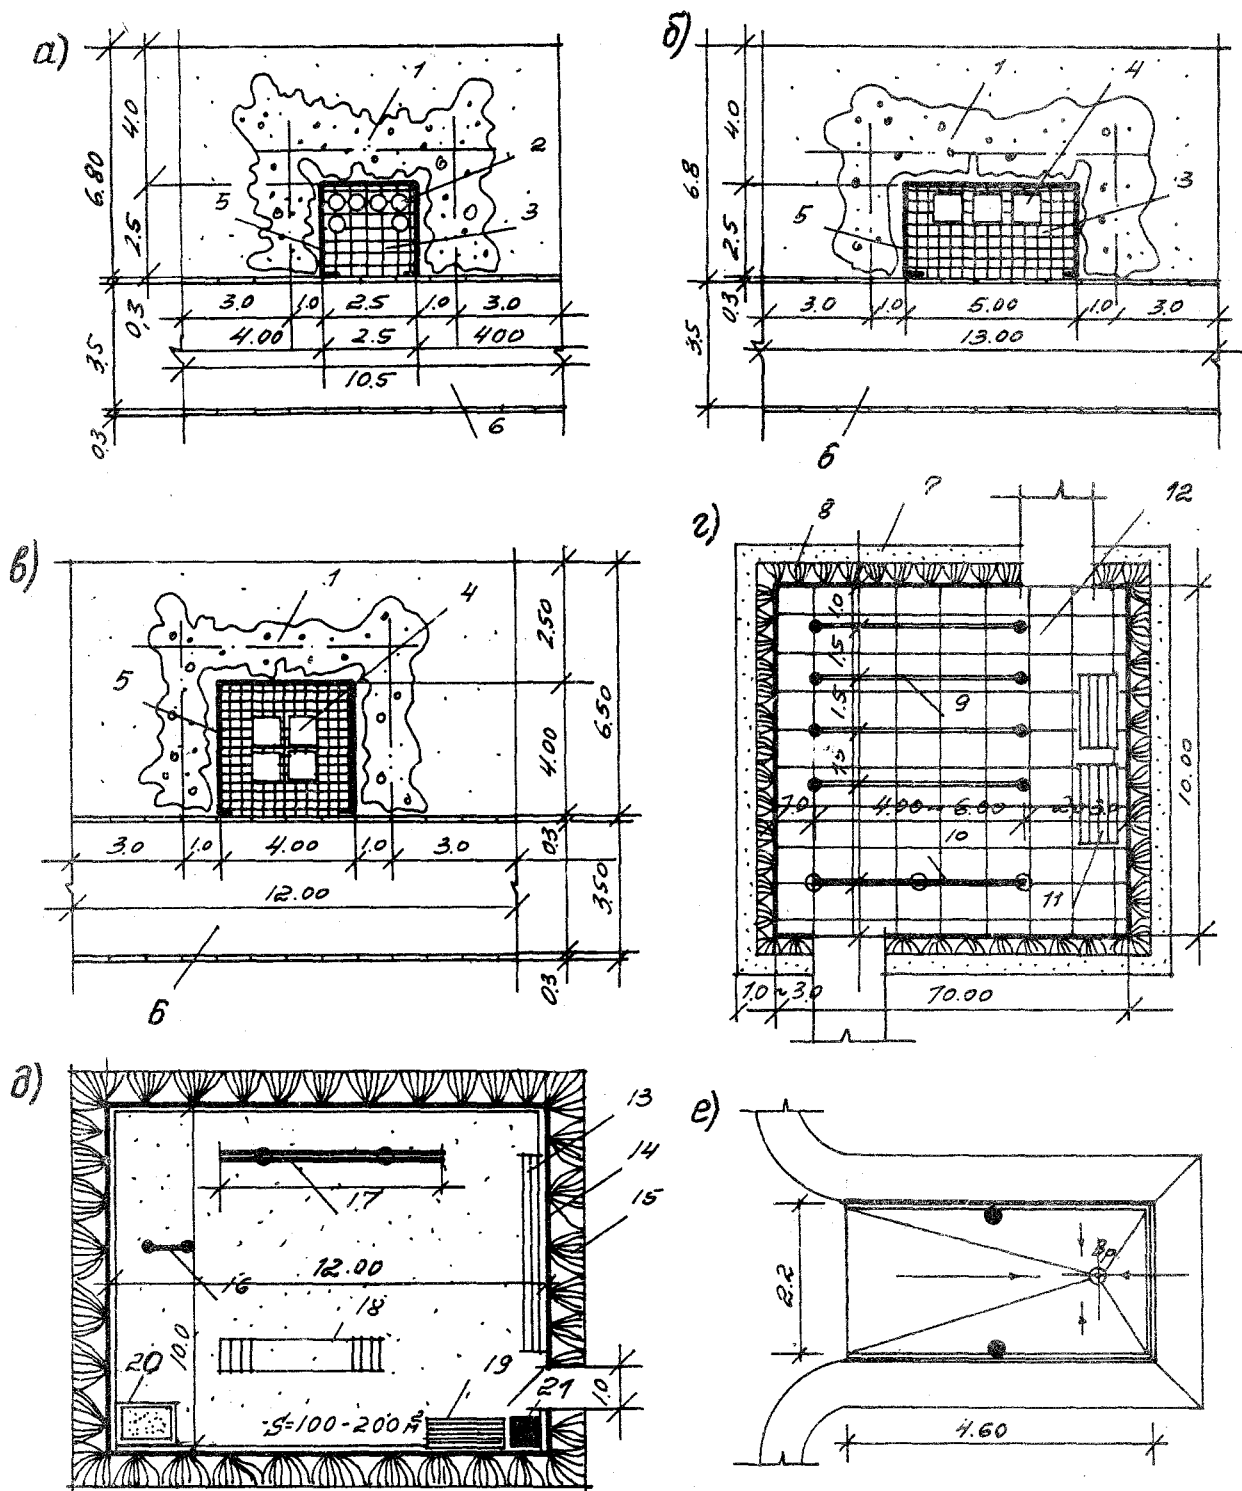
Планировка хозяйственных площадок: а - площадка для мусоросборников с баками; б, в - контейнерные площадки; г - площадка для сушки белья; д - то же для выгула собак; е - то же для мойки автомобилей; 1 - кустарник групповой; 2 - контейнер емкостью 0,1 м³; 3 - площадка; 4 - контейнер емкостью 0,75 м³; 5 - ограда; 6 - проезд; 7 - газон; 8 - кустарник двухрядный; 9 - стойка с веревками; 10 - стойка для чистки ковров; 11 - скамьи; 12 - плиточное покрытие; 13 - дорожка высотой 0,5 м; 14 - ограда высотой 1,2...2,0 м; 15 - кустарник однорядный живой изгороди; 16 - стойка для прыжков; 17 - бревно спортивное высотой 1,2 м; 18 - лестнка; 19 - бункер для инвентаря; 20 - бункер для песка; 21 - мусоросборник
